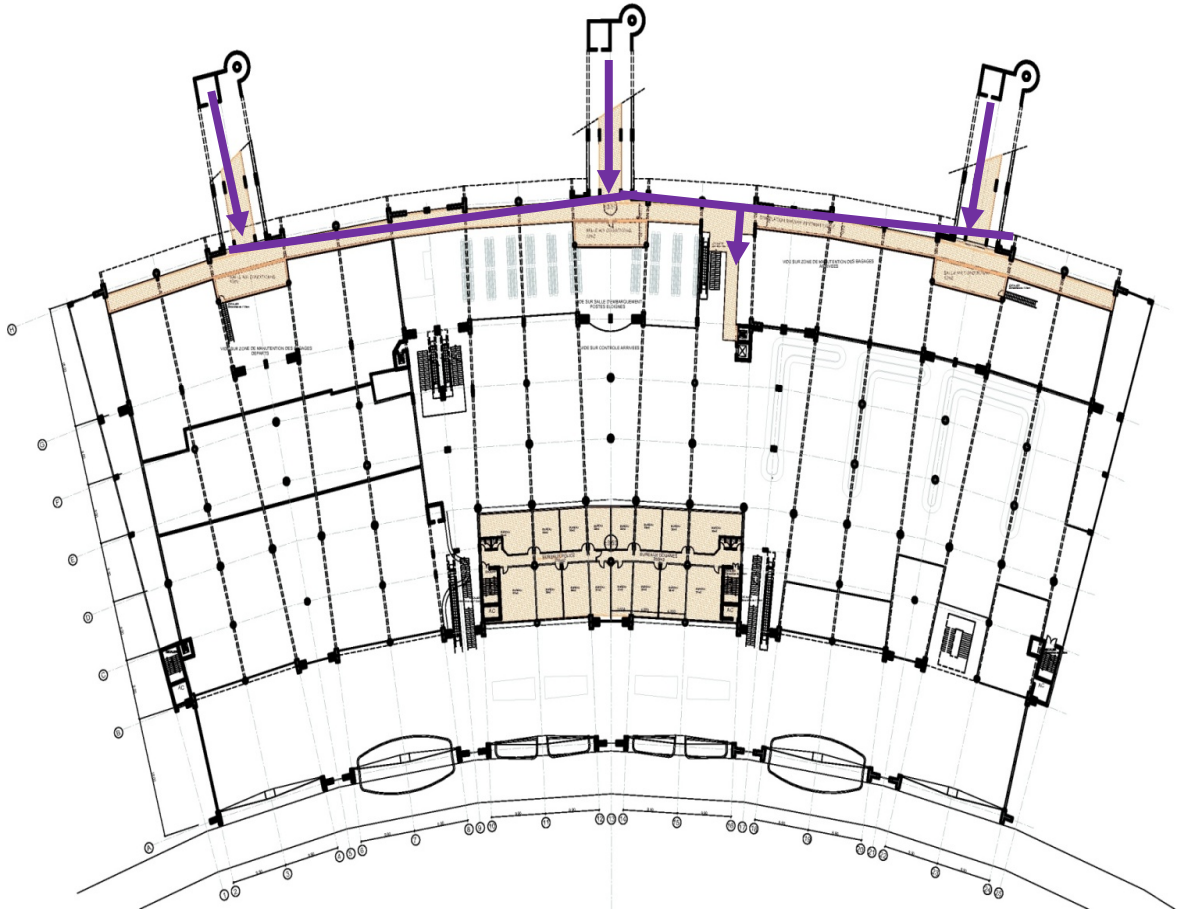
Cheminement passagers -Plan étage intermédiaire
